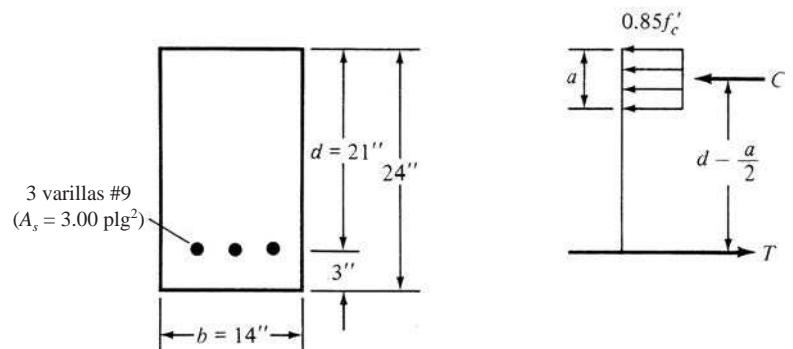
Sección transversal de la viga del Ejemplo 2.8.
